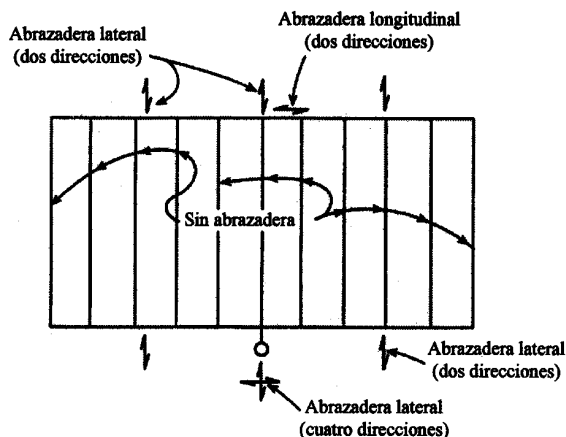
(c) Localización típica de abrazaderas, en un sistema tipo emparrillado.
